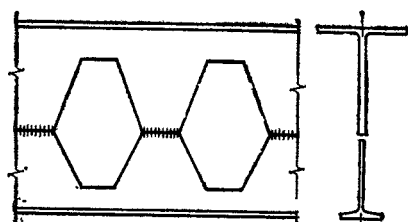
Пример сечения балки пролетом 12 м для путей подвешенного подъемно-транспортного оборудования из бистальной сквозной двутавра
